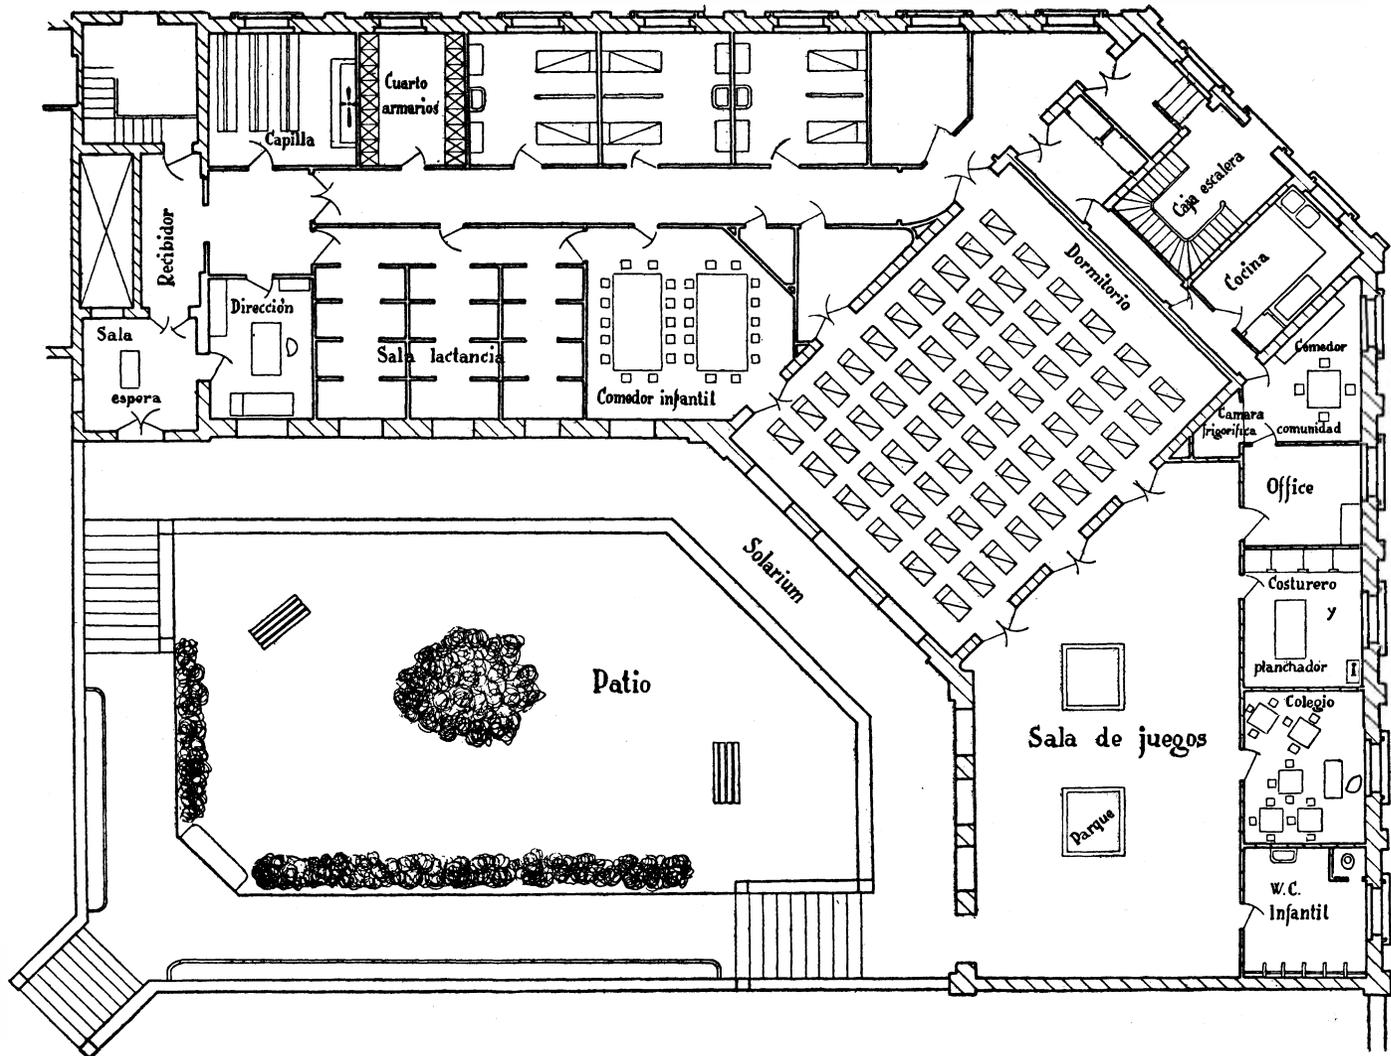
Plano de la Guardería de la Empresa Batlló.
